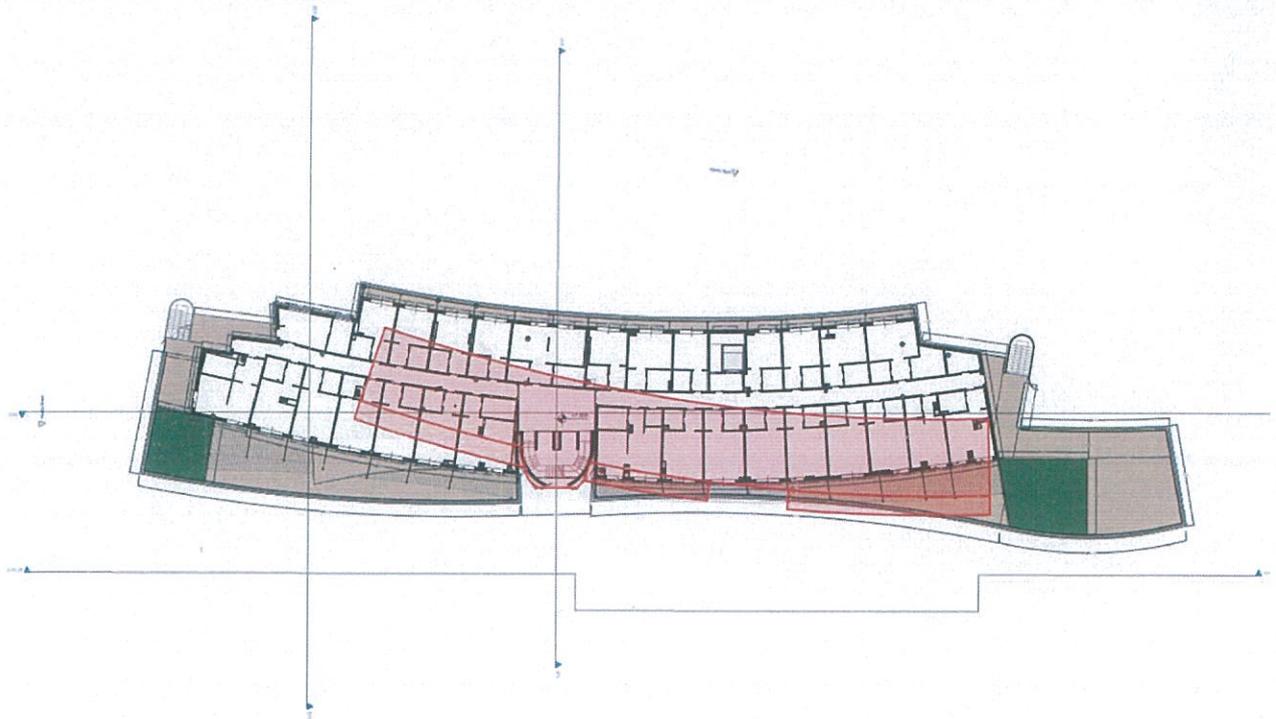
Planimetri e katit te dyte (kuota +7.80)
